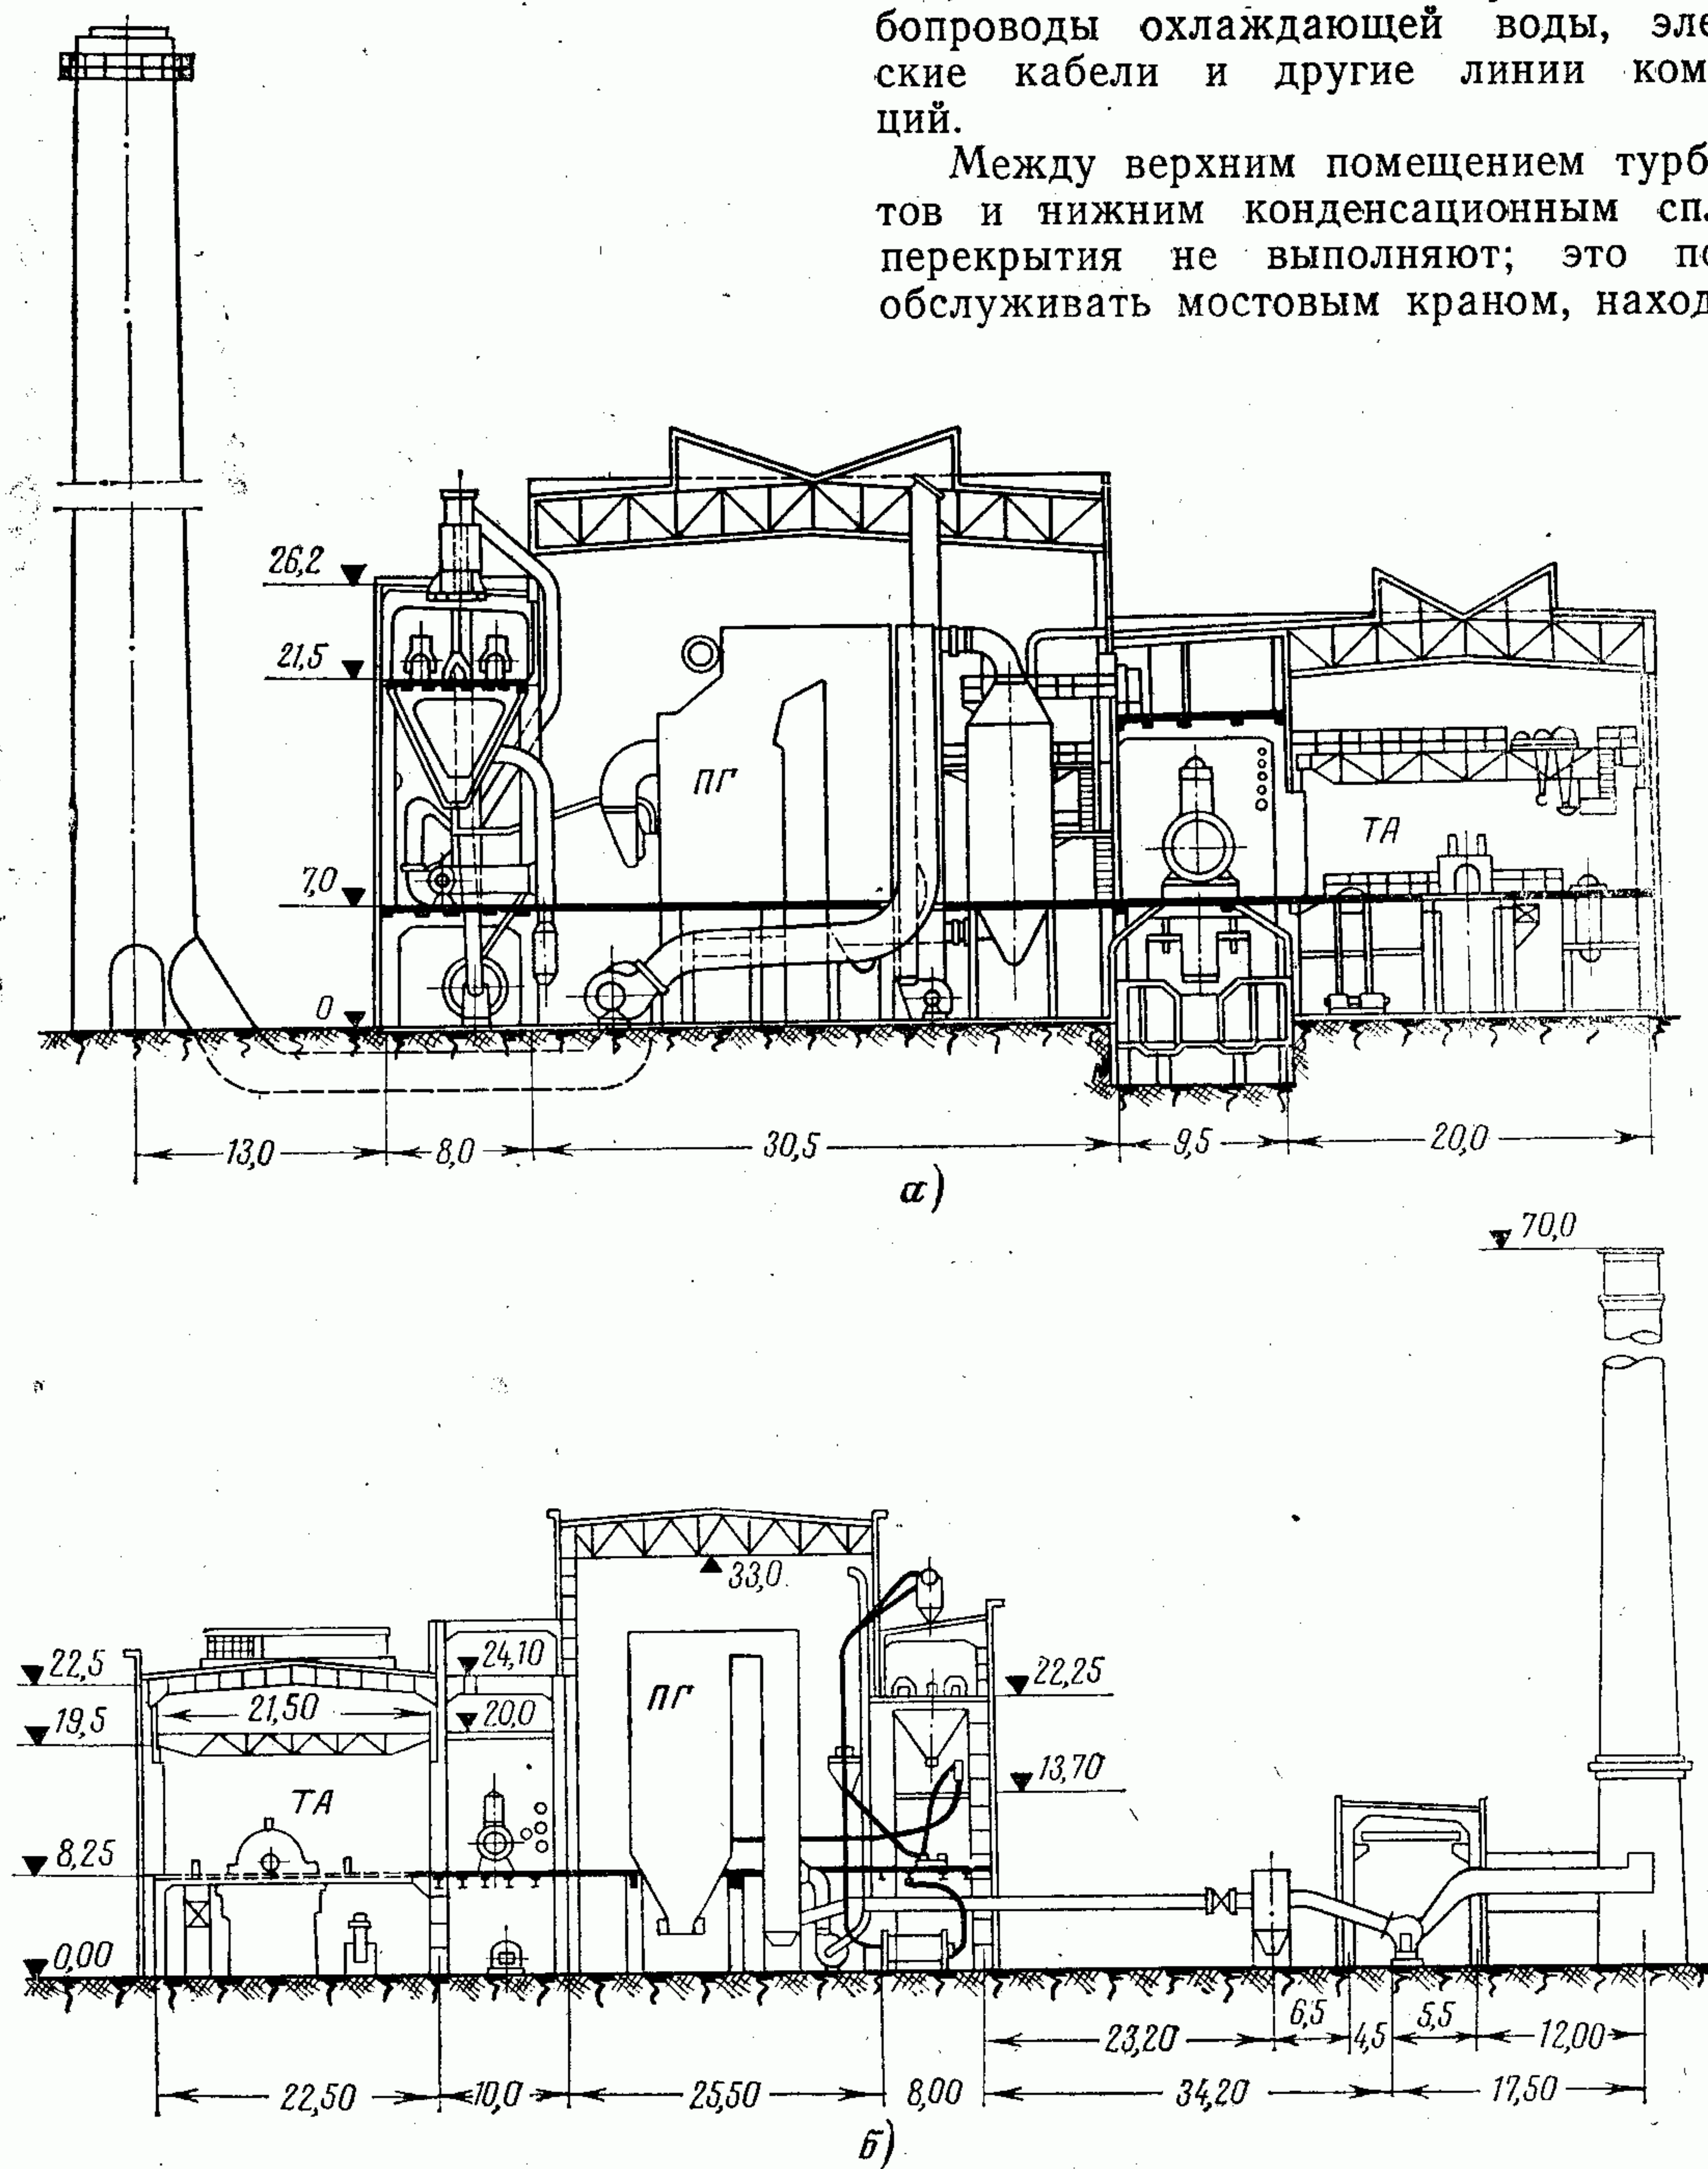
Поперечный разрез главного корпуса пылеугольной электростанции с наружным бункерным отделением и нижним размещением тягодутьевой установки.
